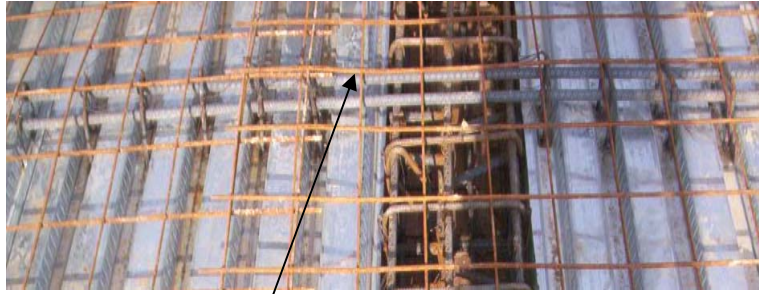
Conjunto Refuerzo Vigas y Placa.
